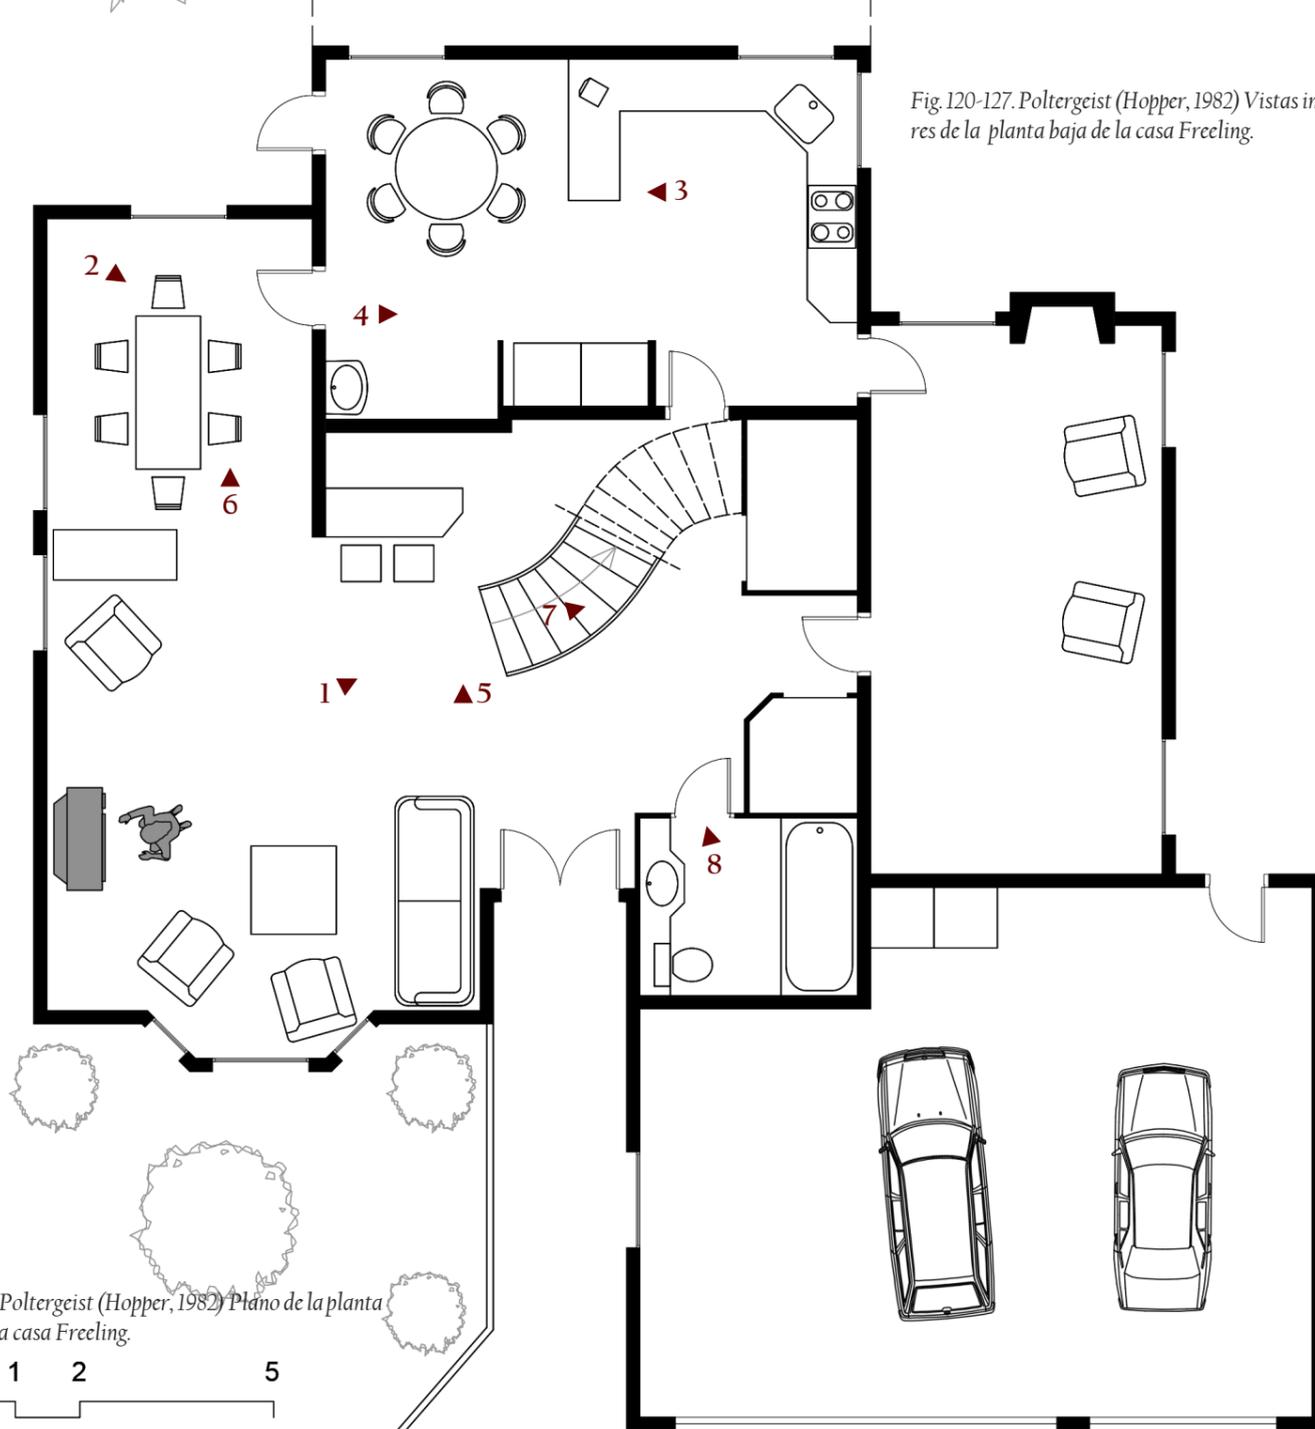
Poltergeist* (Hopper, 1982) Plano de la planta baja de la casa Freeling.
